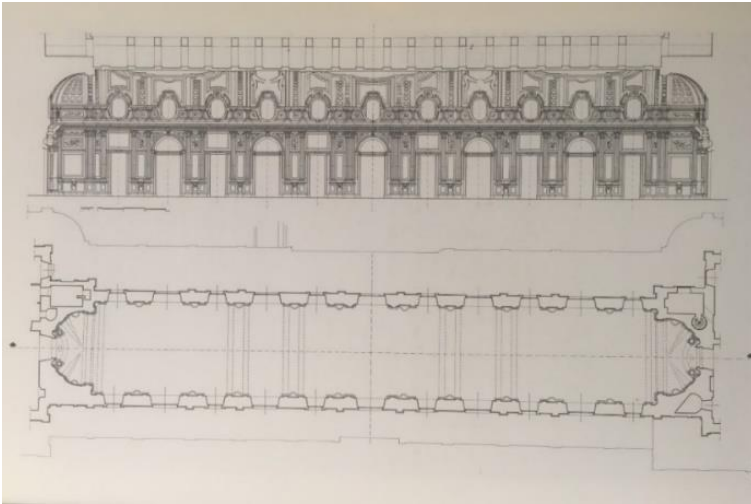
Sezione longitudinale e pianta della Galleria Grande¹²²
